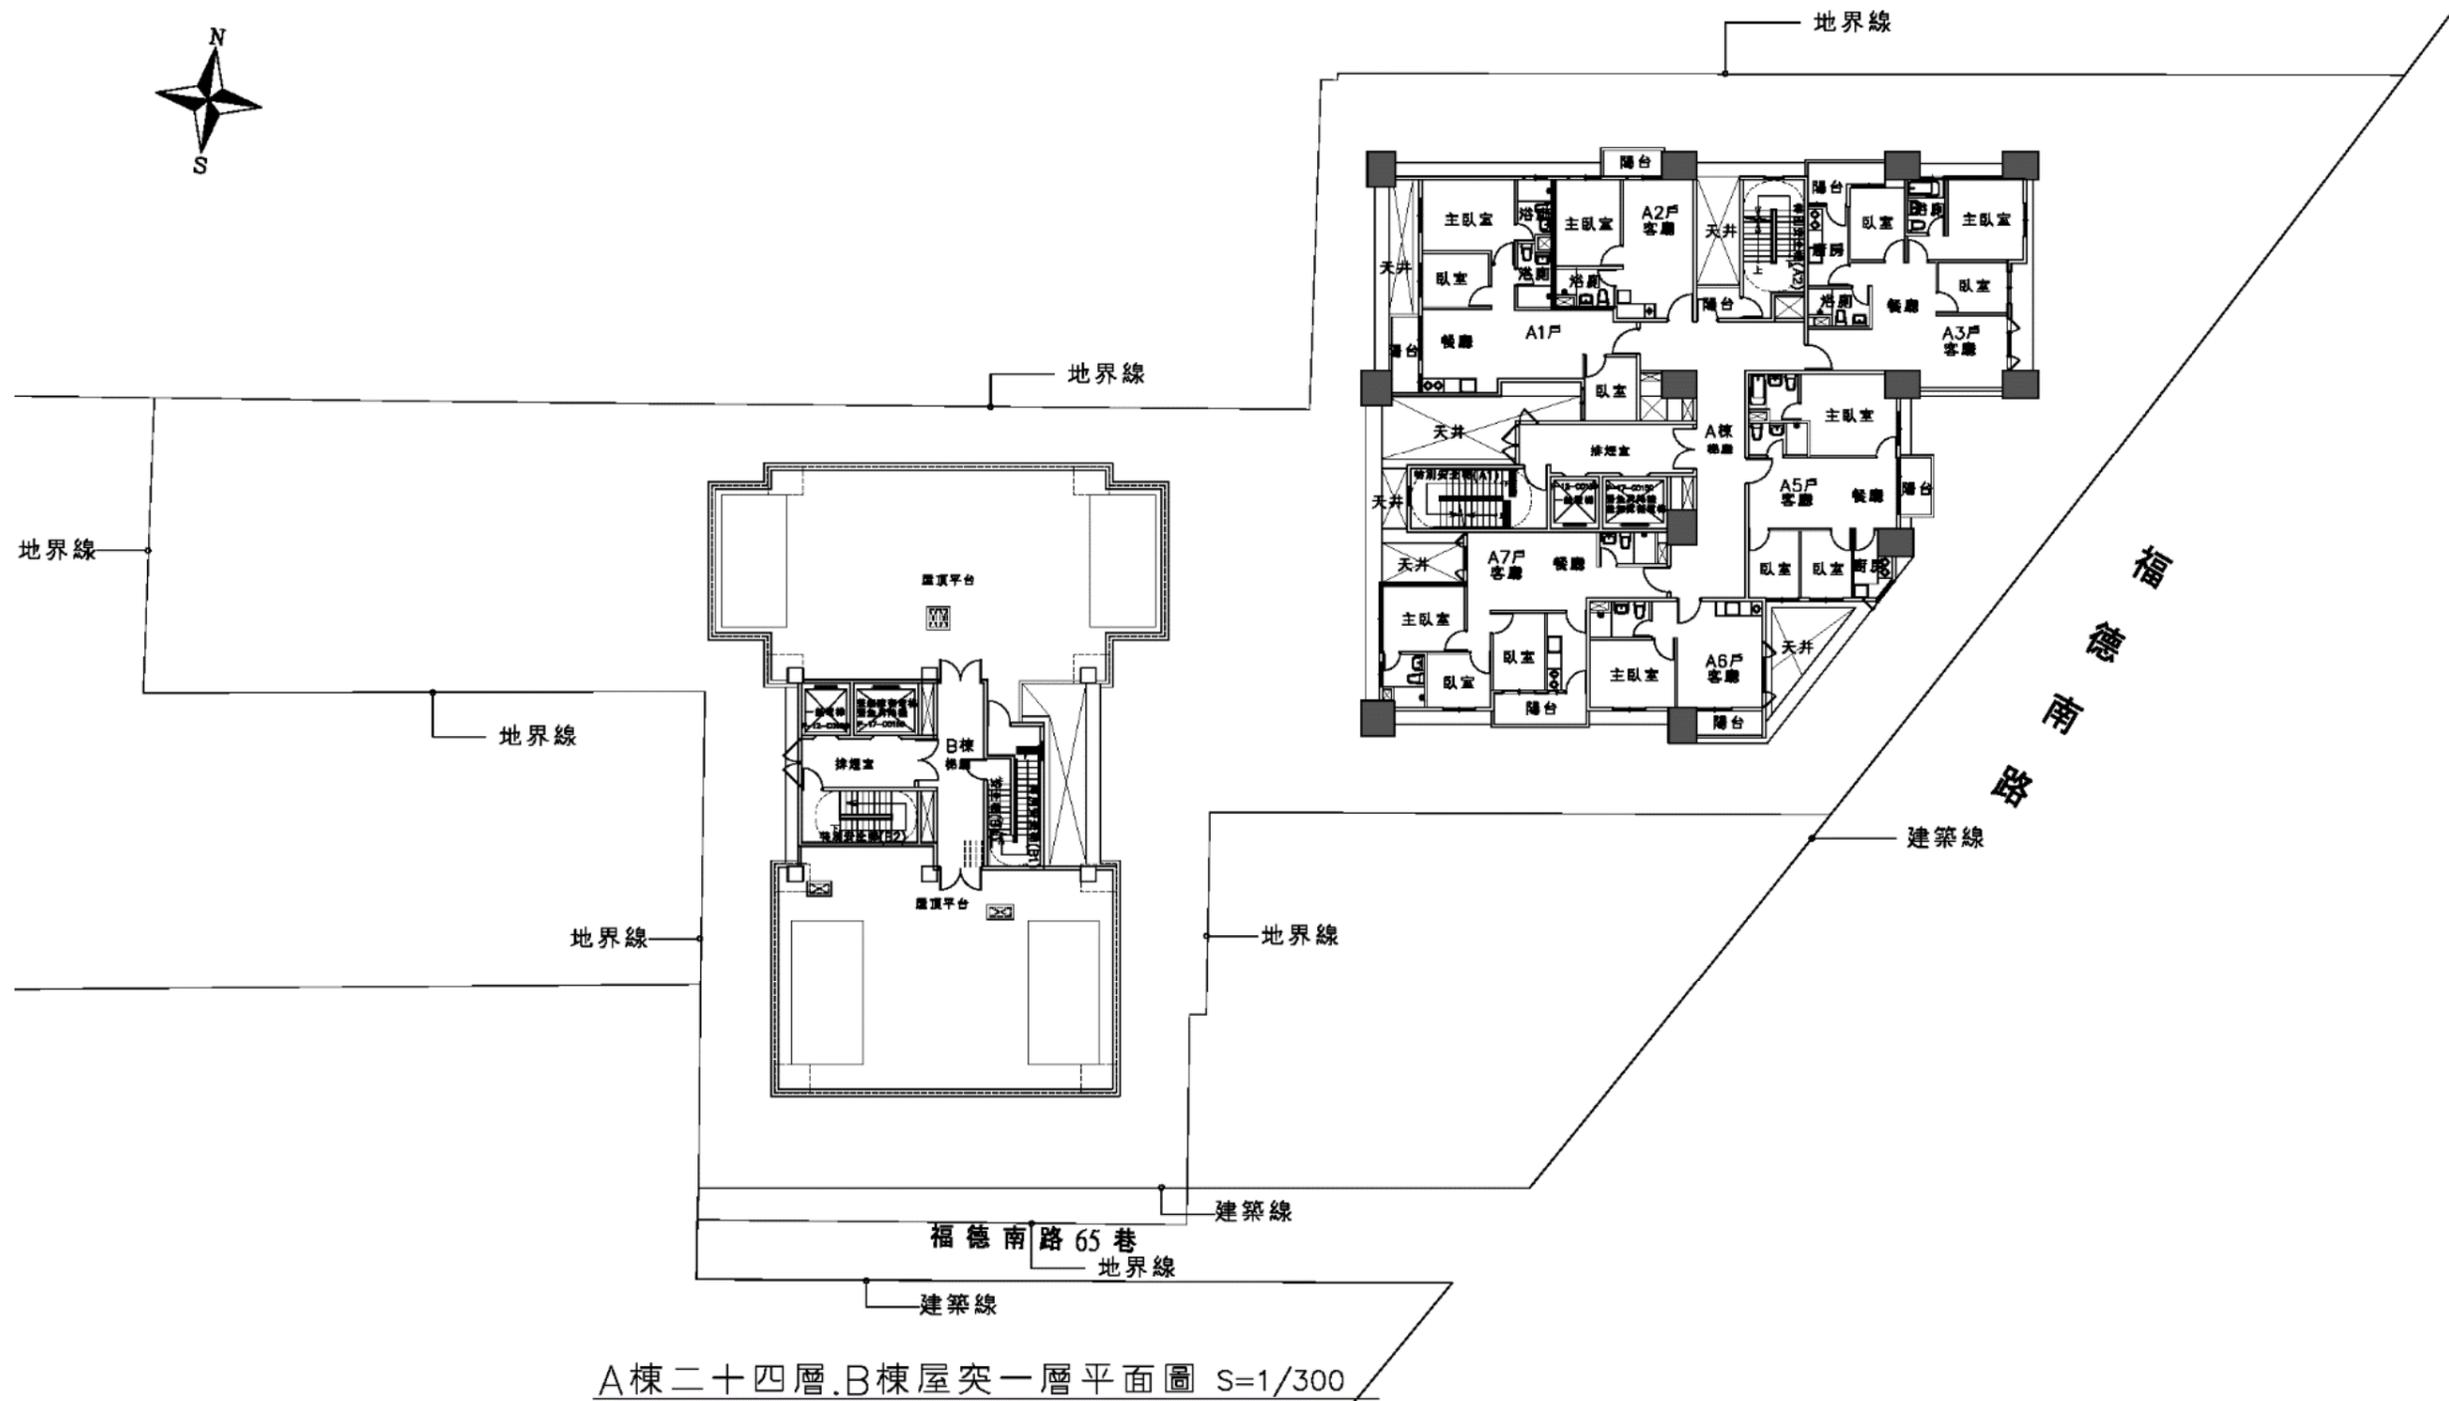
A 棟二十四.B 棟屋突一層平面圖 (S:1/300)
